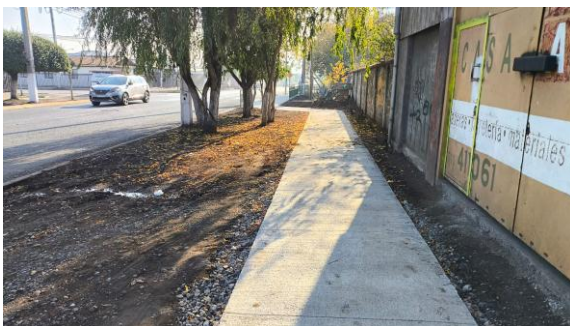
CONTRUCCIÓN VEREDA NORTE AVENIDA COMALLE.
